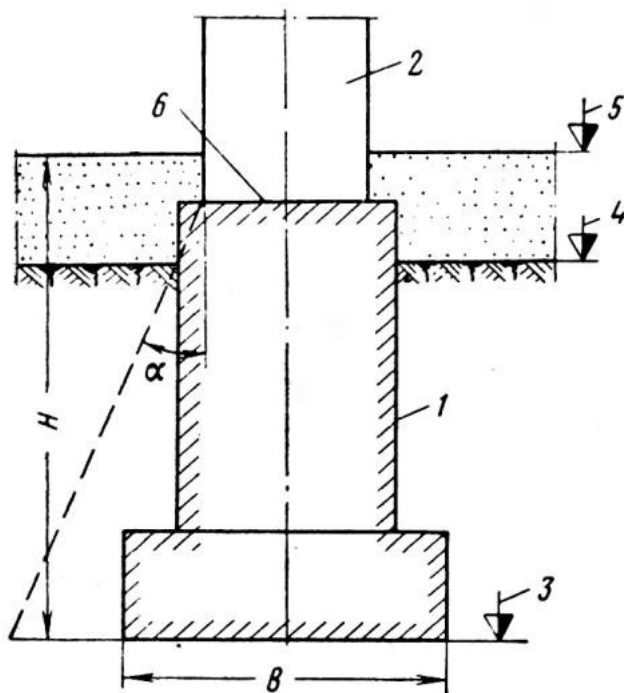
Схема фундамента на естественном основании: 1 — фундамент; 2 — наземная часть сооружения; 3 — отметка подошвы фундамента; 4 — отметка поверхности грунта; 5 — отметка планировки; 6 — верхний обрез фундамента; H — глубина заложения фундамента; B — ширина фундамента
